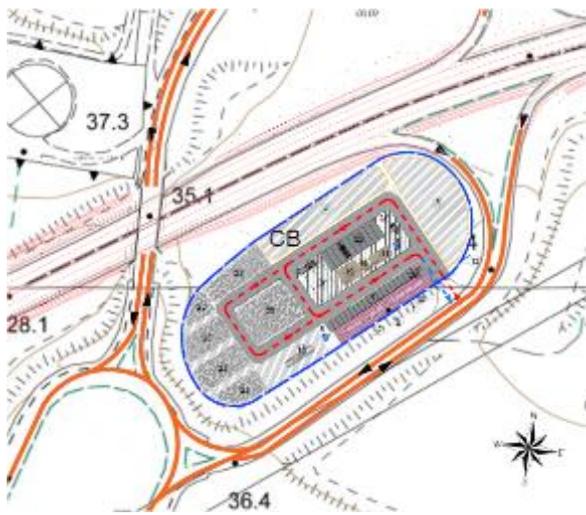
Layout del Cantiere Base dell'asse principale e mitigazione ambientale delle aree
